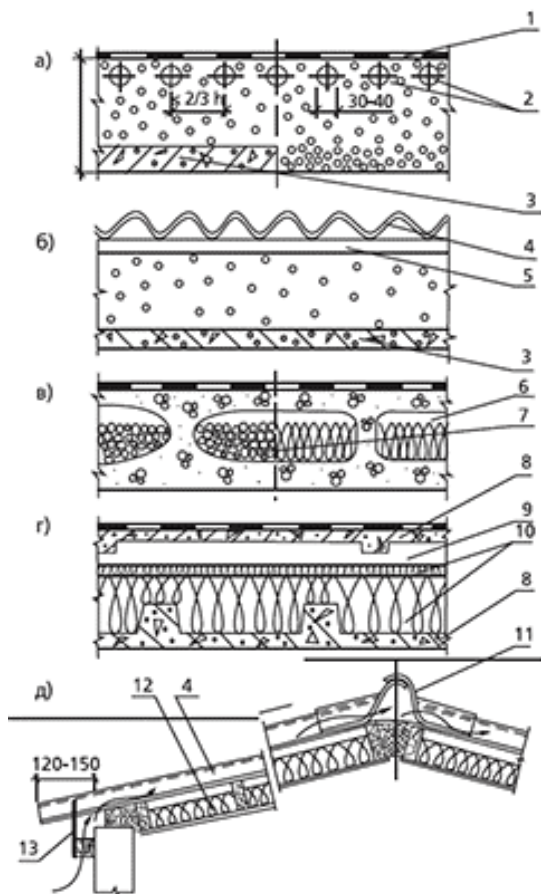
Вариант вентилируемой кровли с применением асбестоцементных листов: состав слоев сверху вниз: 1 – гидростеклоизол, 2 – цементная стяжка с армированием, 3 – рубероид РПП, 4 – волнистые асбестоцементные листы, 5 – сухая стяжка из ЦСП 20 мм, 6 – разуклонка из песка по слою пергамина, 7 – пенополистирол ПСБ-С, 8 – пароизоляция, 9 – железобетонная плита
